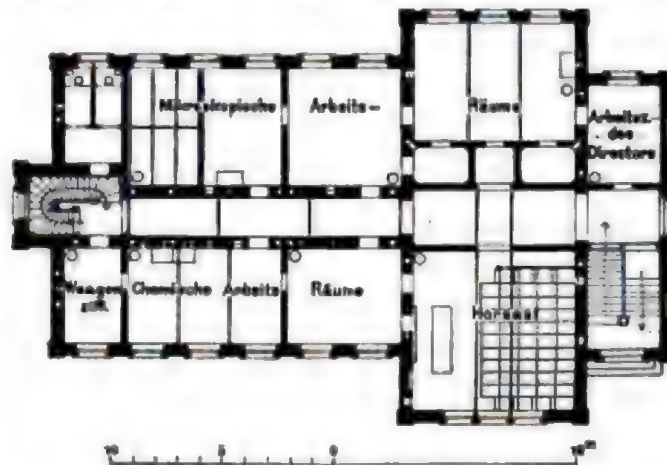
Grundriss vom Hauptgeschosse.
